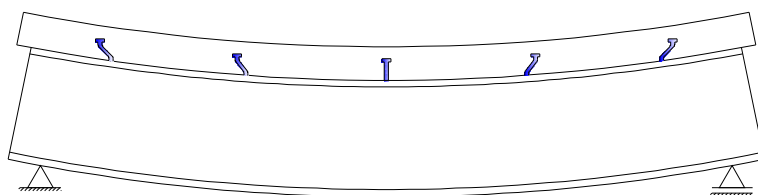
Deformada de uma viga mista com interação parcial.
